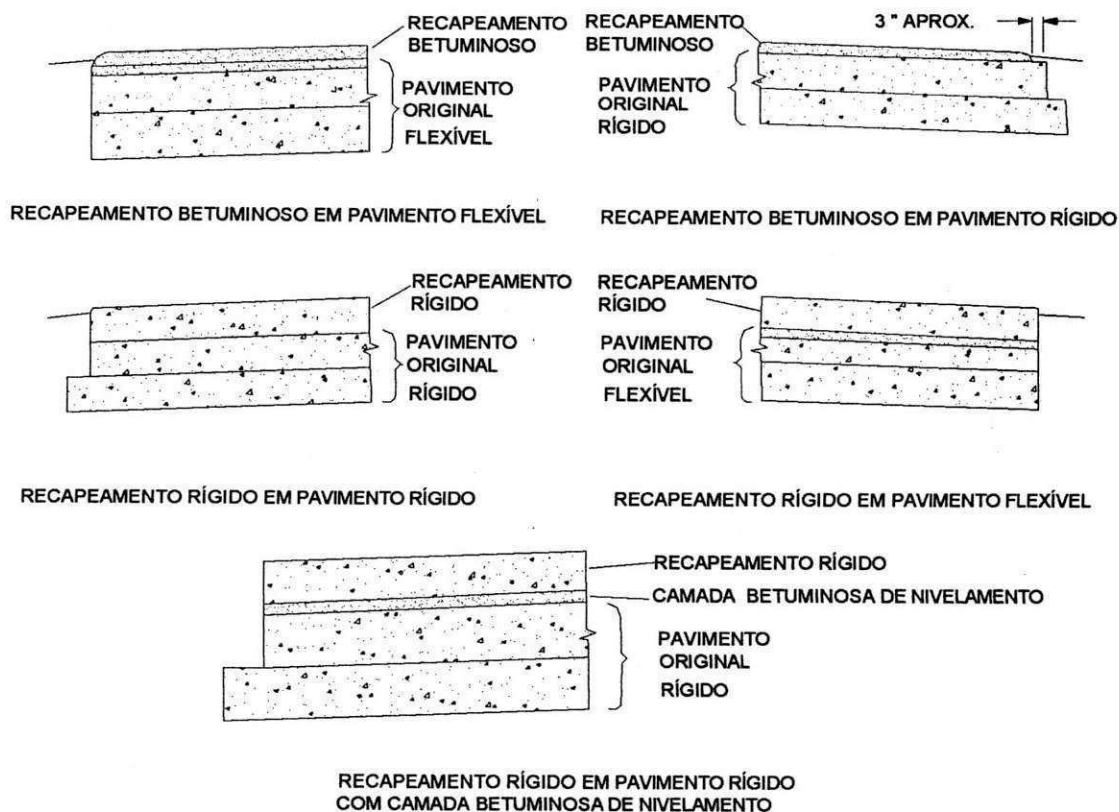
Estrutura de recapeamento de pavimentos de aeroportos (FAA, 1995).
